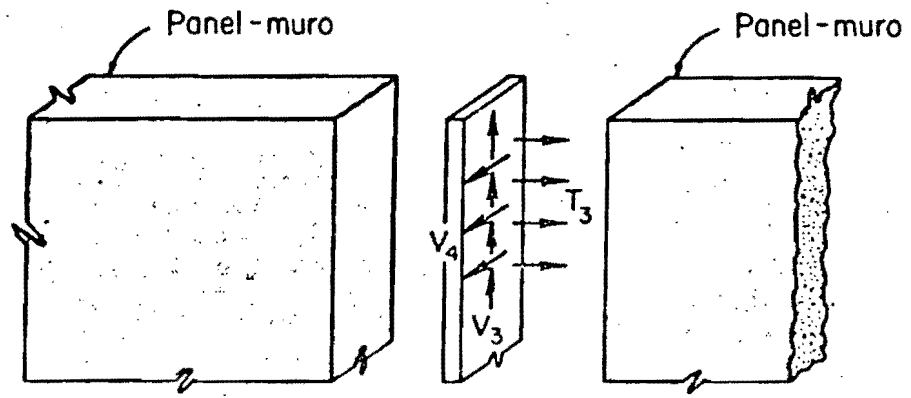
Fuerzas sobre una conexión vertical muro-muro (ref 8)
